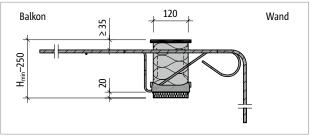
Schöck Isokorb® XT Typ K-WU: Produktschnitt
